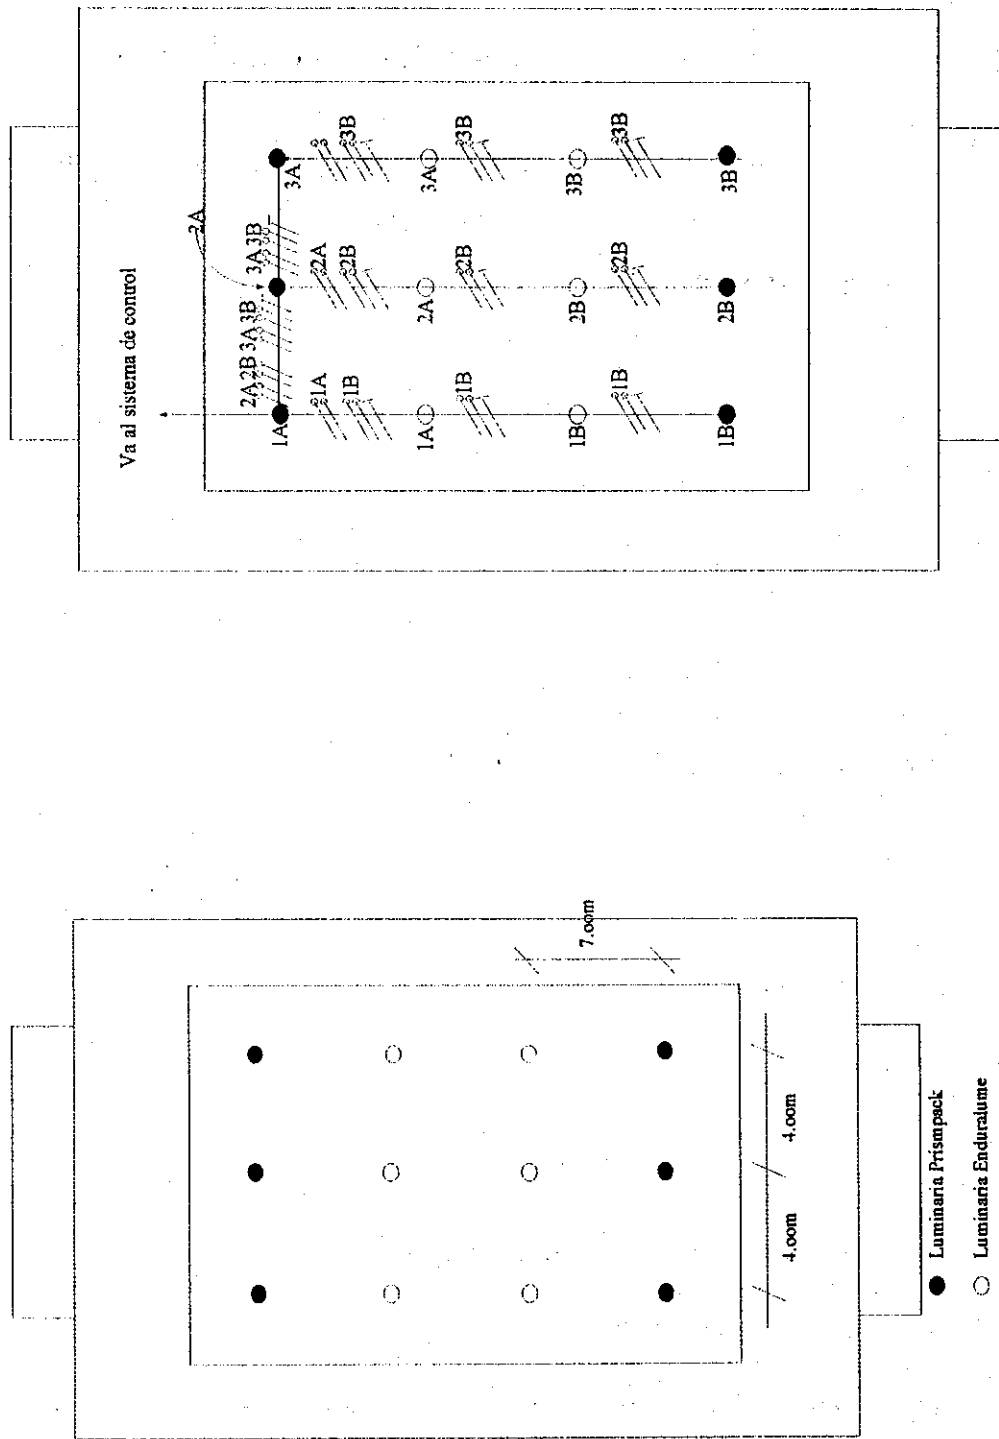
(sin fuente). Ubicación de luminarias y plano de cableado.
